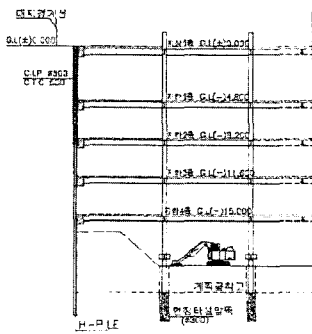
SPS 공법 시공순서도 STEP-5 (GL-16.6m까지 굴착 & 지하4층 철골 거치)
